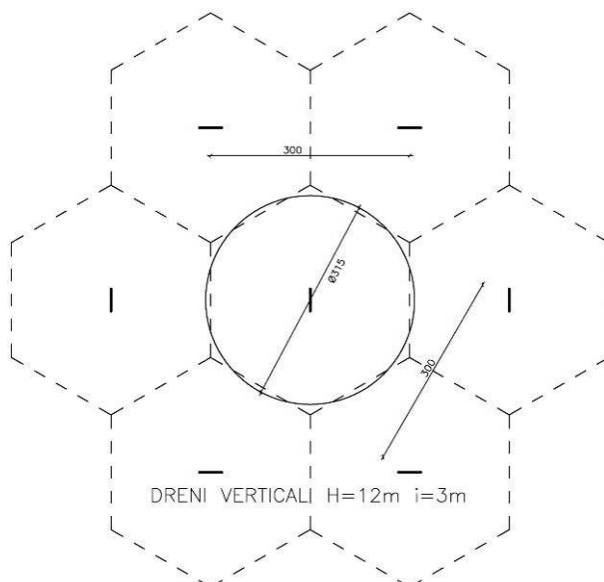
disposizione planimetrica dei dreni verticali e area di influenza di ciascun dreno.
